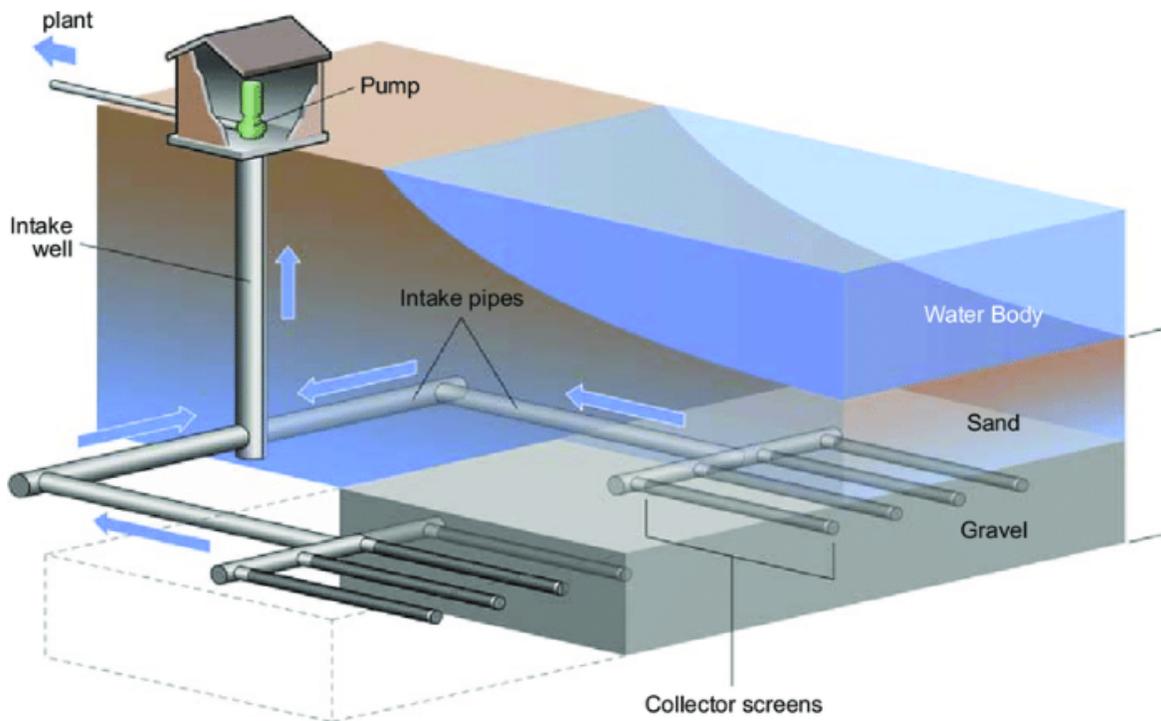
Galería de Infiltración (Fuente: Desalination Engineering Planning and Design, Nikolay Voutchkov)
